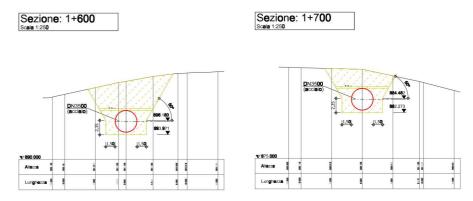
Le sezioni di posa a monte e a valle della strada vicinale interferita.
